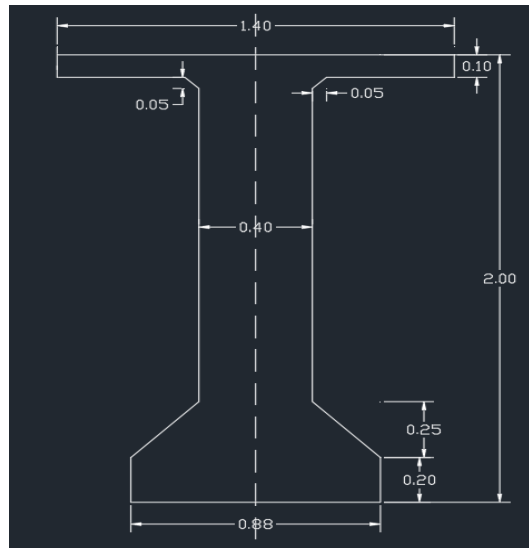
Coupe Transversale sur appuis d'une poutre du tablier
